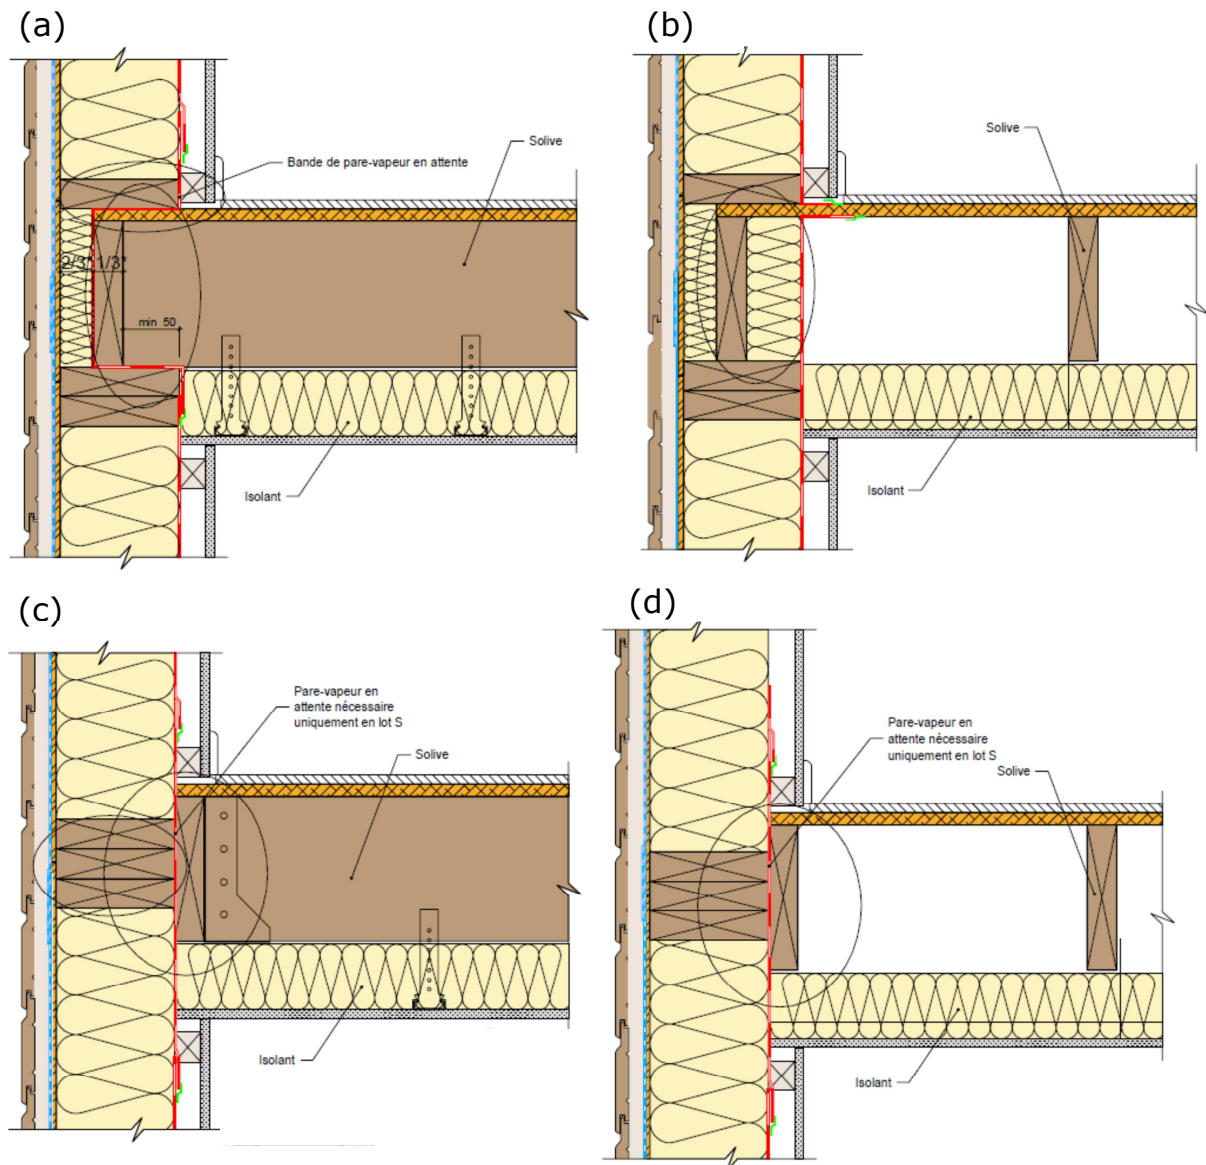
Exemples de jonction en T plancher – façade ; (a) et (b) planche sur lisse haute, (c) et (d) plancher sur muraille.
